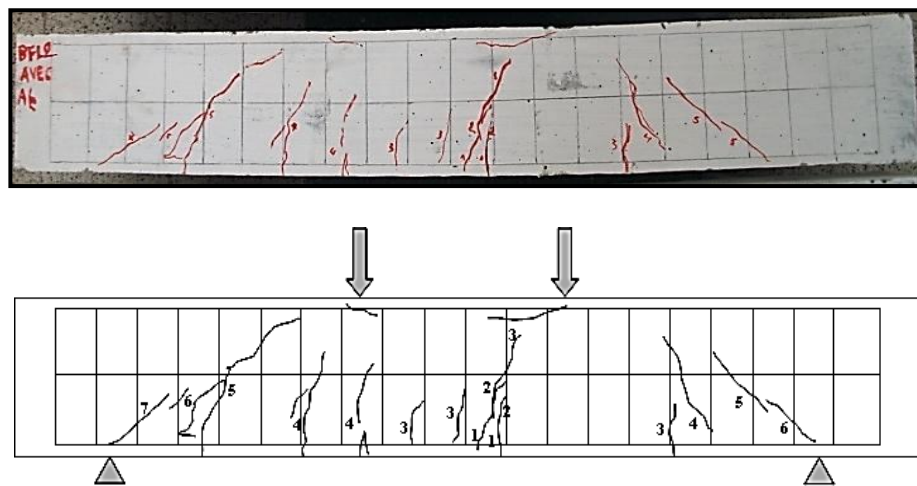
Destruction et fissuration finale de la poutre PBFL2 avec At.
